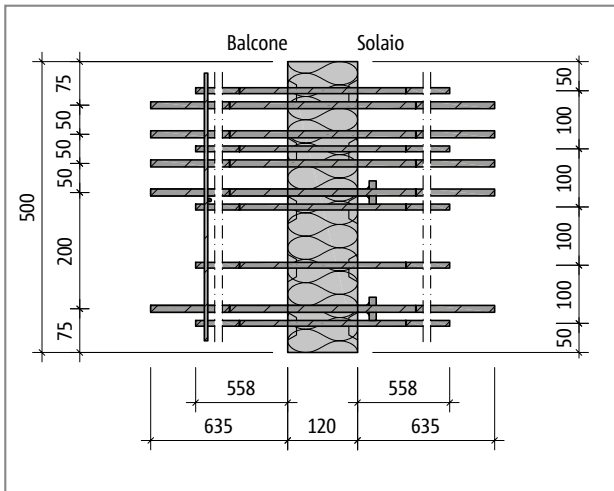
Schöck Isokorb® tipo EXT30-L-V10: pianta del prodotto
